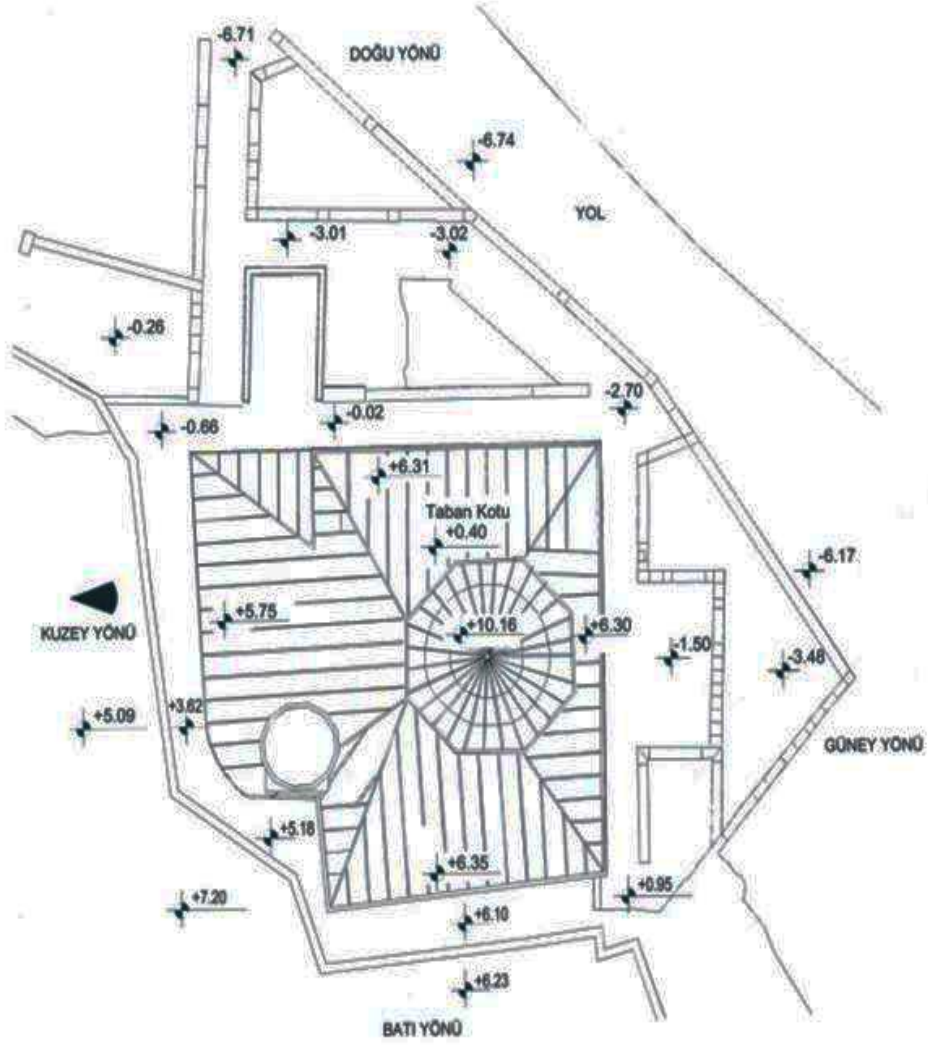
Zemin Kat Planı (+1.50 kotu).
